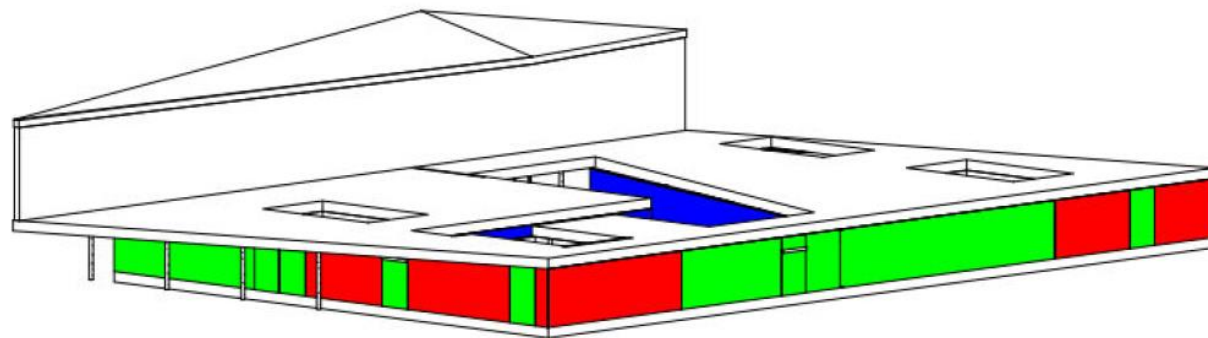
Bâtiment voyageurs – traitement de la façade Sud-Est (AREP)
